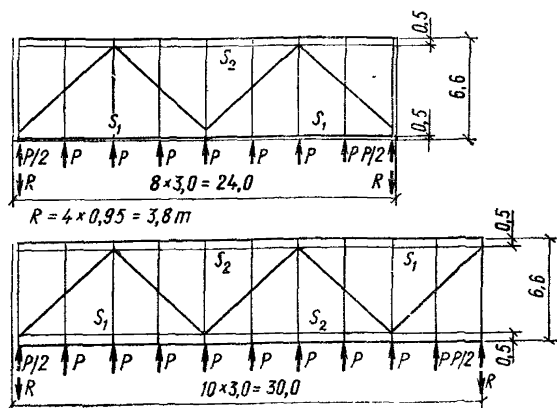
Определение усилий в поясах верхней связевой фермы от ветровой нагрузки
